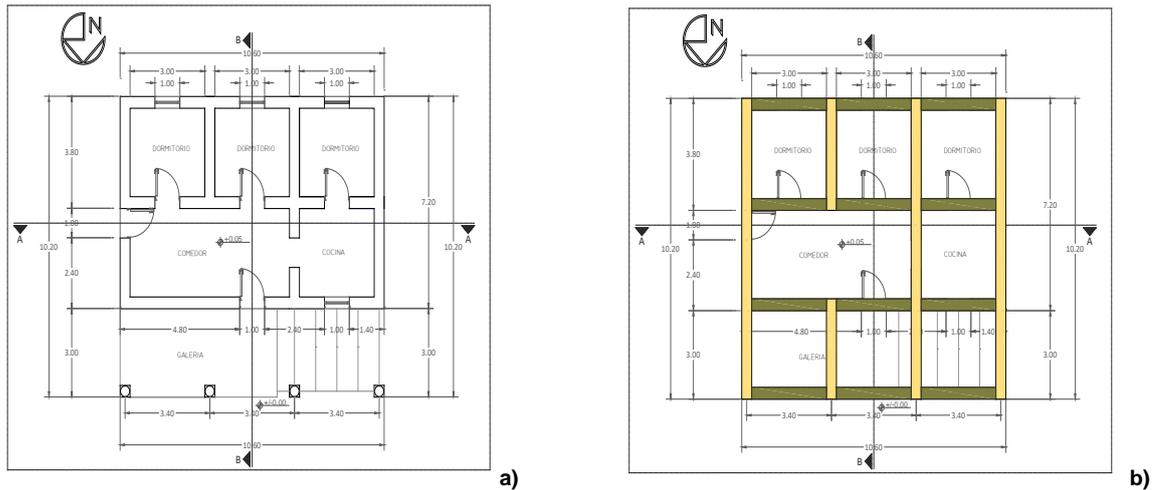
Planta general de la vivienda de la Muestra 2: a) análisis funcional b) dirección de los muros
